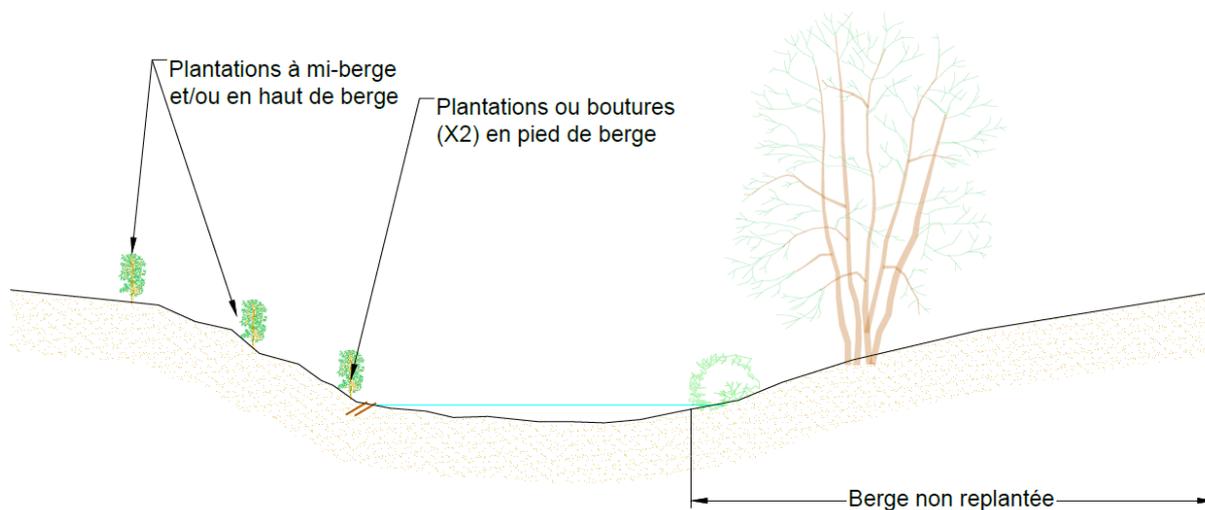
Coupe de principe de plantation type 2 : toute la berge
